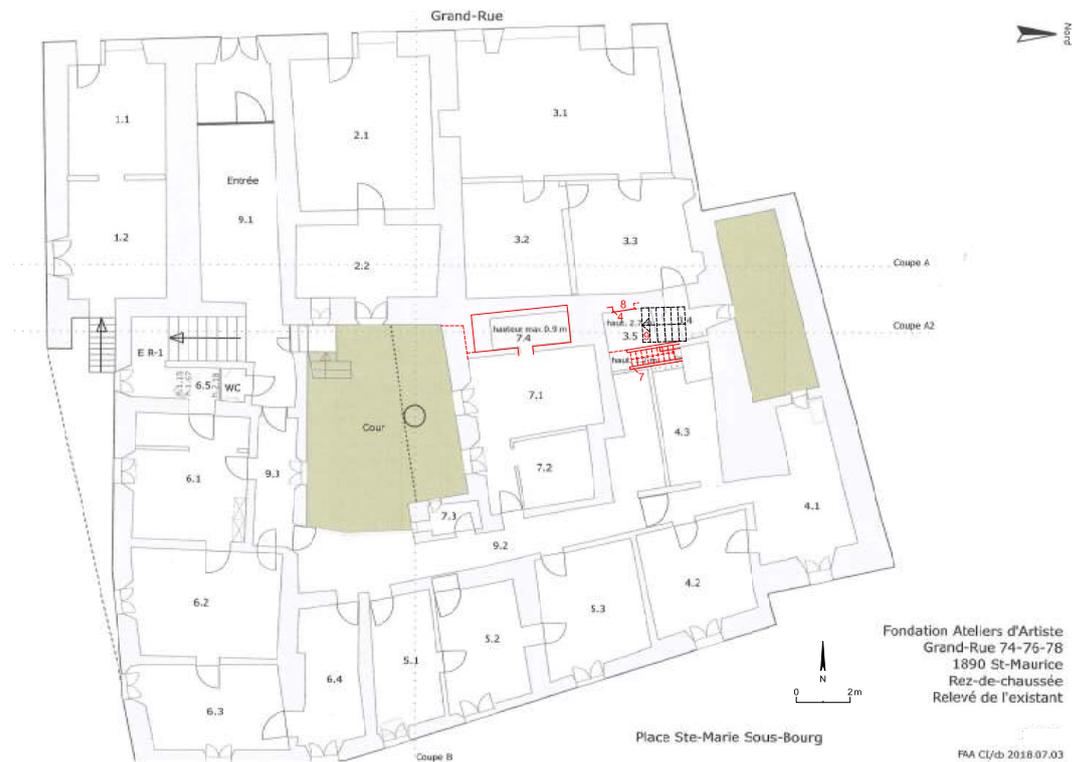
Plan du rez-de-chaussée du bâtiment. En rouge, les éléments archéologiques observés sur place. Sur la base du levé effectué par la Fondation Ateliers d'Artiste.
